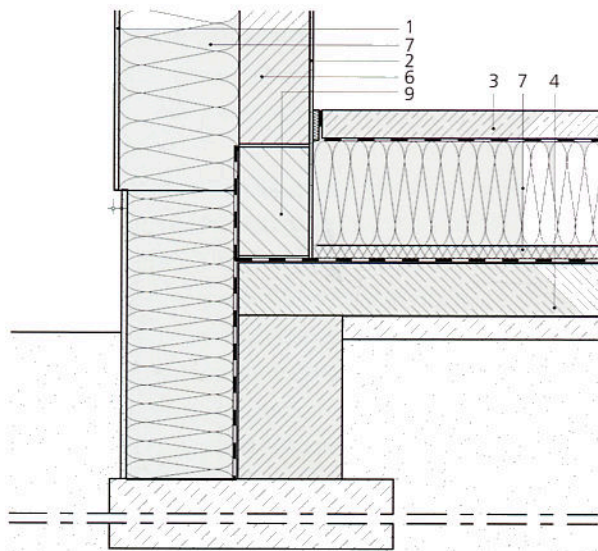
Détail de construction : coupe du fondement et du plancher isolé à l'intérieur
